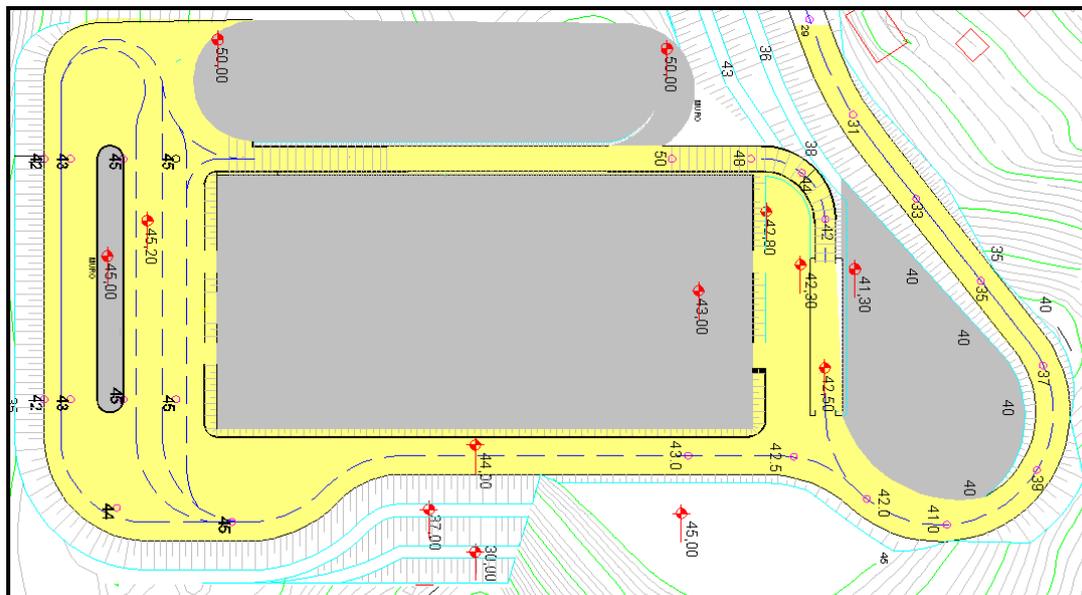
Situação final do terreno para instalação da parte terrestre do TGSC
